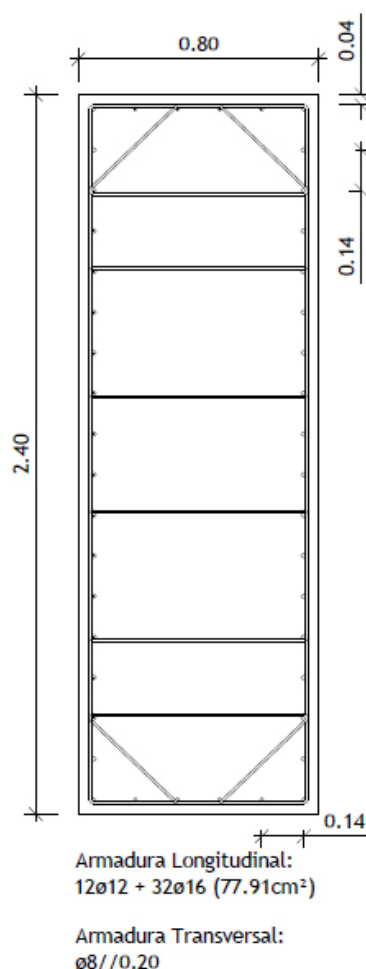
Esquema de armaduras longitudinais e transversais dos pilares do caso de estudo
